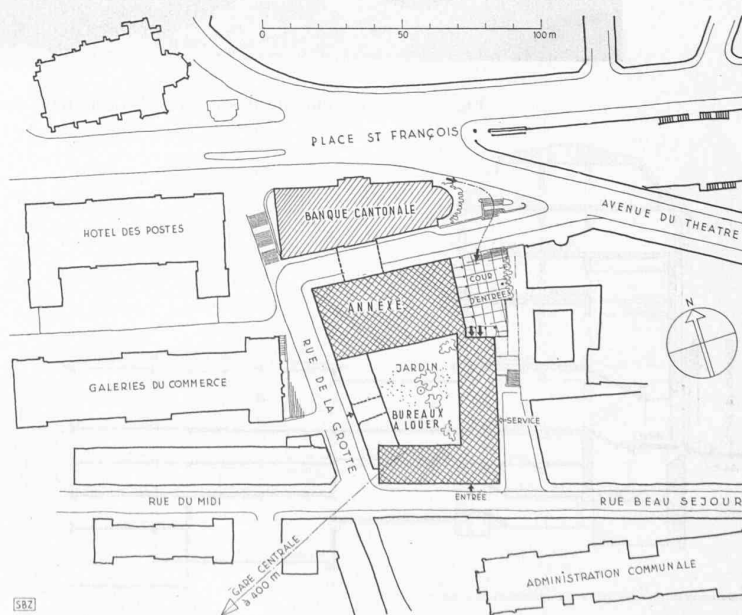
Plan de situation. Echelle 1 : 2500.
